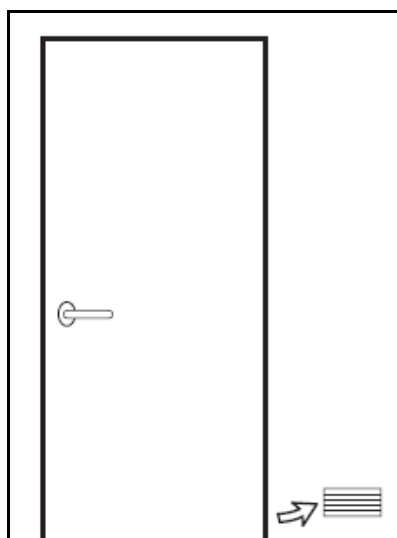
Pormenor dos dispositivos de passagem de ar [26]
